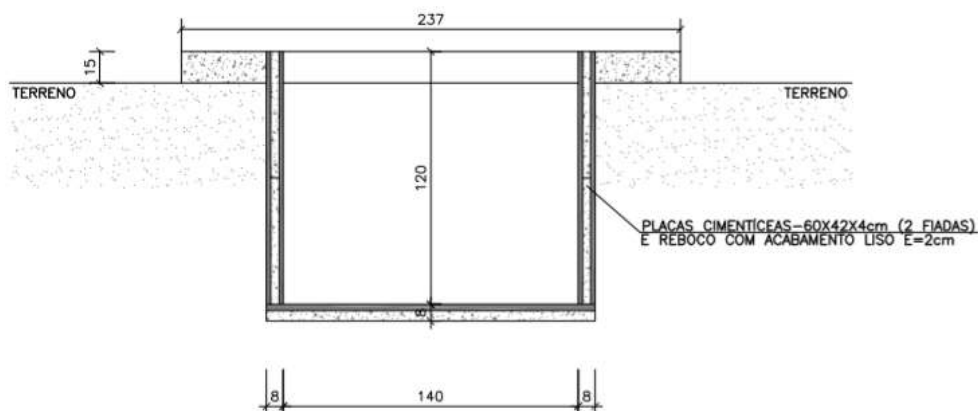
Caixa de Sedimentação com canaleta de entrada – Corte B-B'
